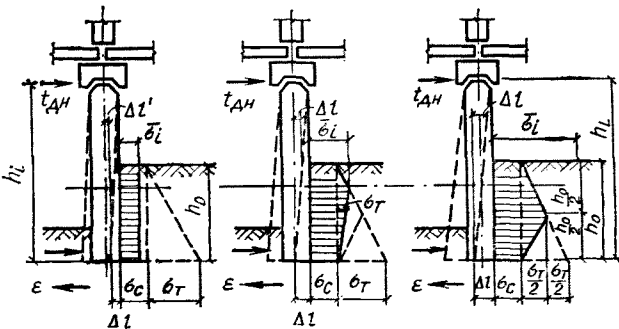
Схемы эпюр бокового давления, вызванного смятием грунта при наклоне фундаментов
